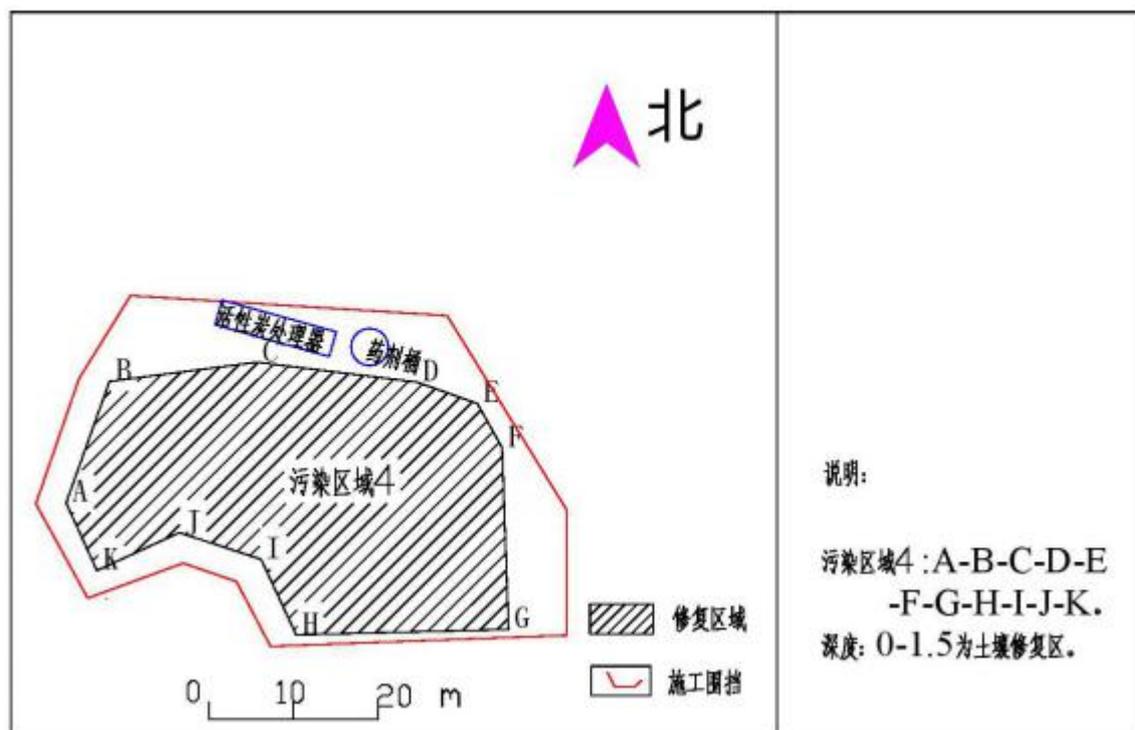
贾寨镇草林张村污染场地施工平面图（红色线为施工作业面）
